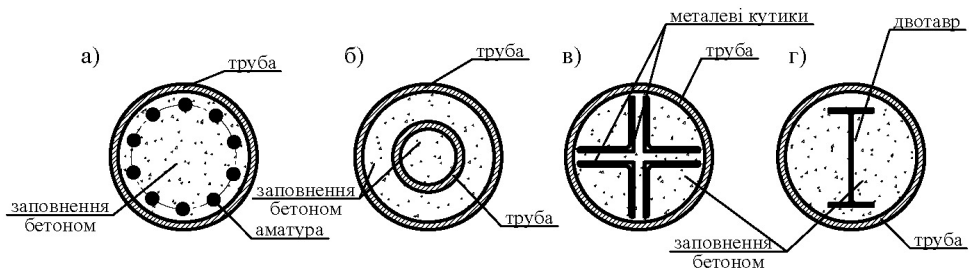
Трубобетонні колони: а – армування бетонного ядра гарячекатаною арматурою; б – армування бетонного ядра трубою меншого діаметру; в – армування бетонного ядра металевими кутиками; г – армування бетонного ядра двотавром
